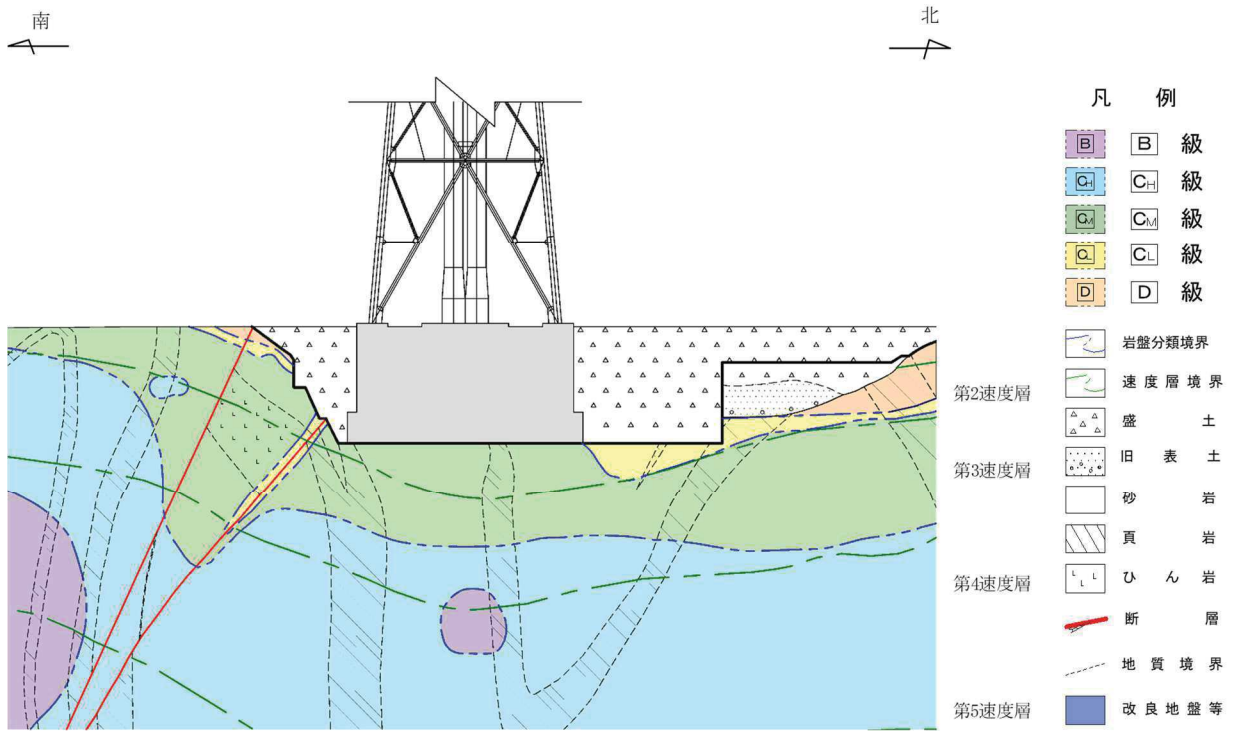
排気筒の地質断面図 (⑤-⑤断面)
